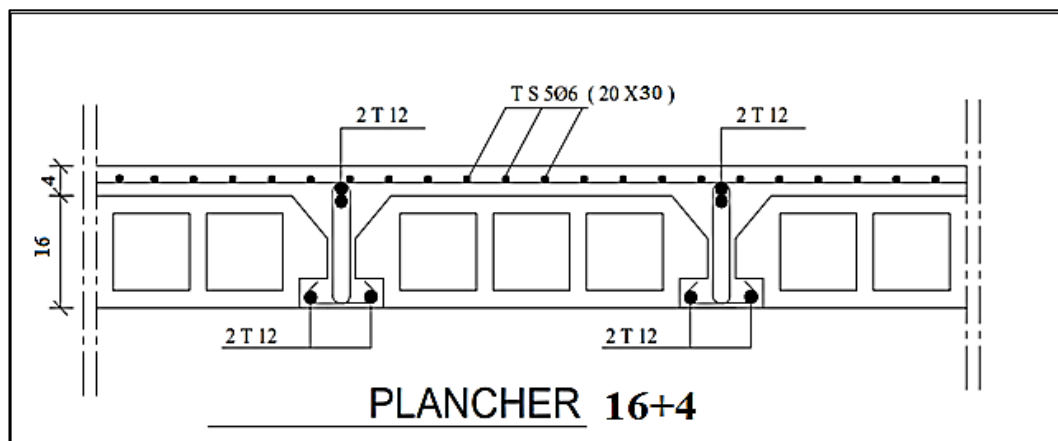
ferrailage des poutrelles des planchers (étages + terrasse)
